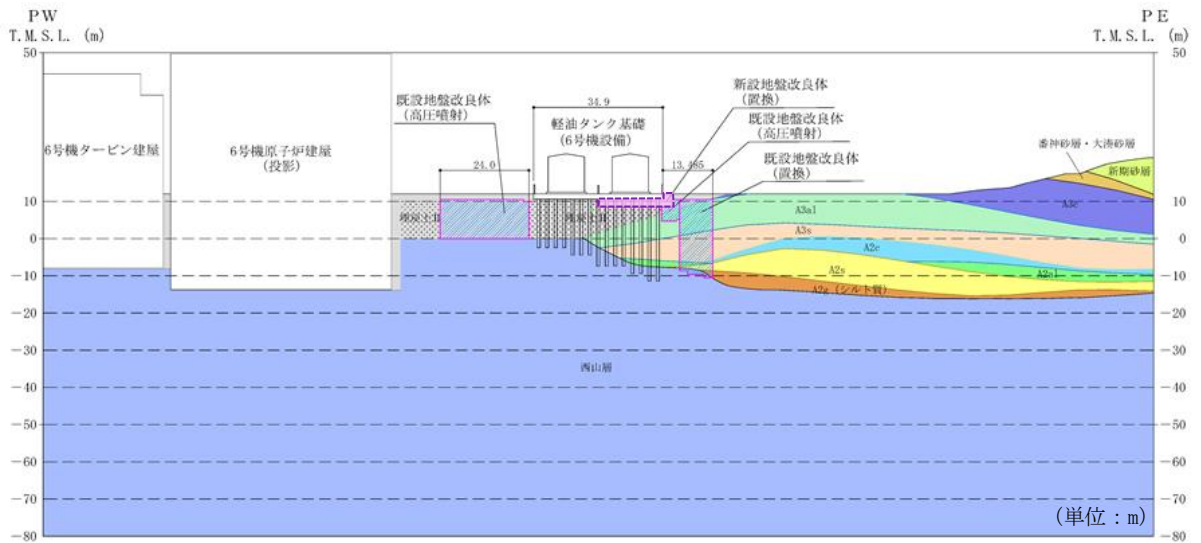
常設代替交流電源設備基礎の地盤改良体配置図
